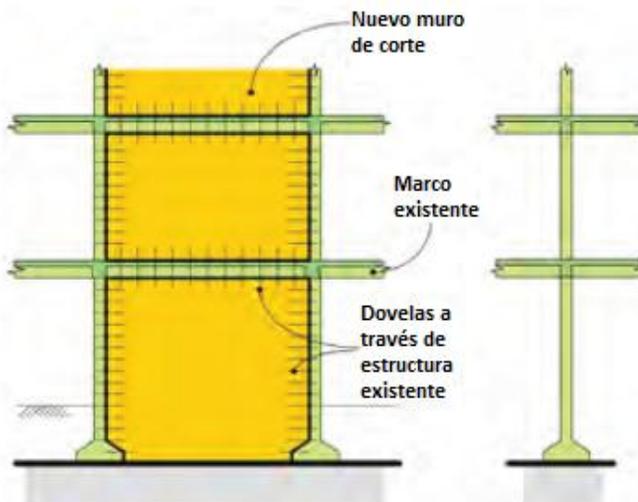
Instalación de nuevos muros de corte de CR en un edificio existente de marcos de CR – notar que se proveen dovelas para amarrar la nueva estructura con la vieja (fuente: C.V.R. Murty, adaptado de Gulkan et al. 2002).
